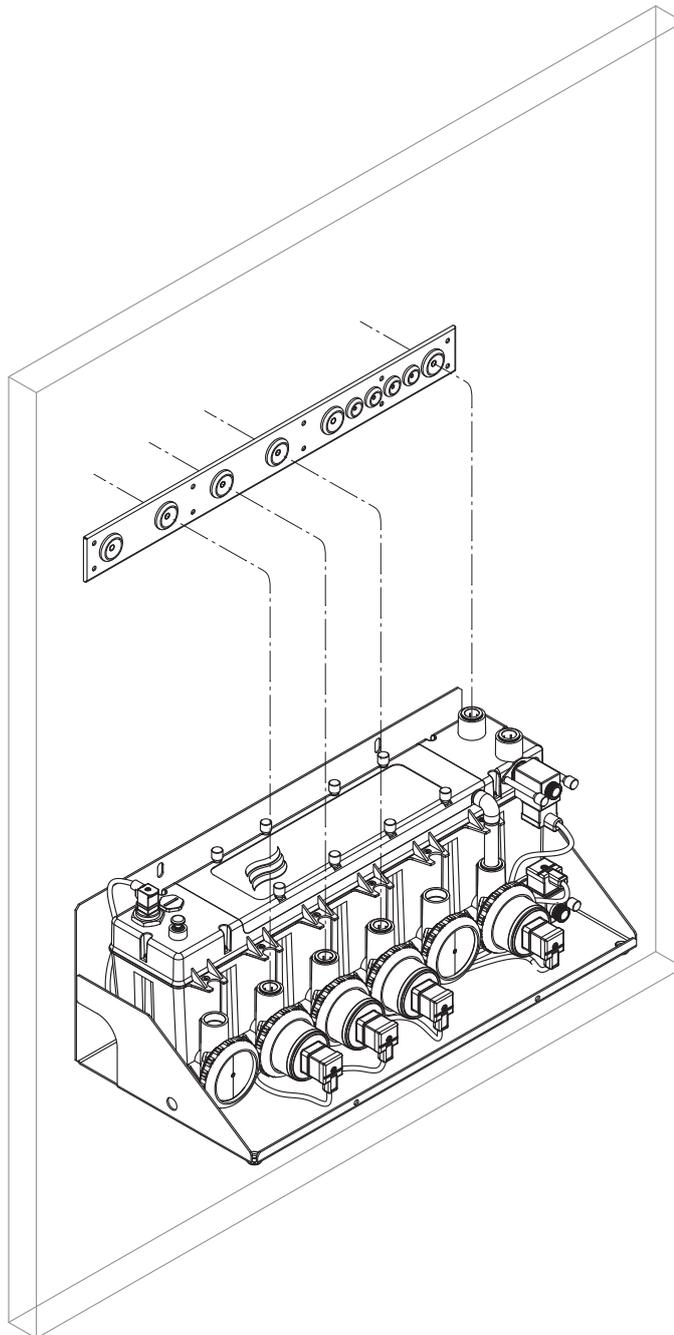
Durchführungsbohrungen markieren (Aussenmontage)
